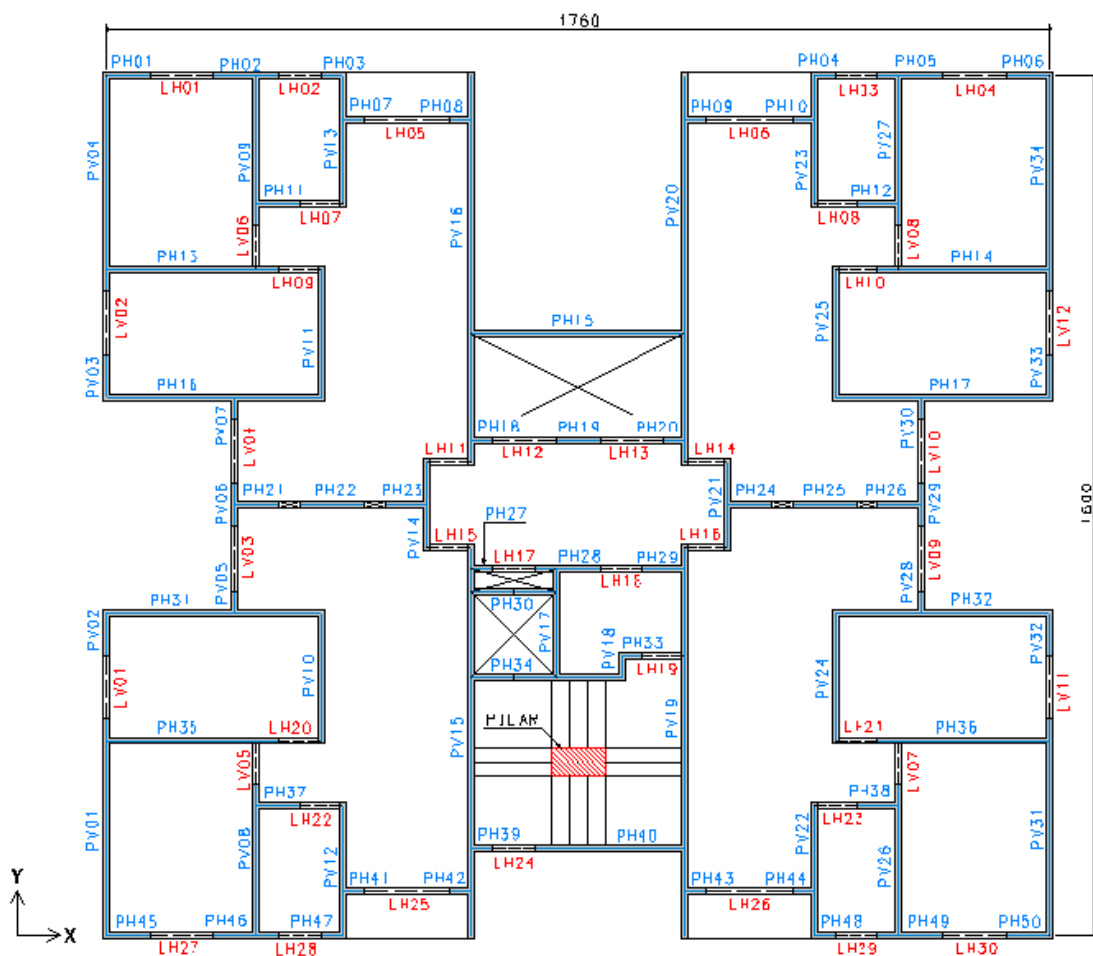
Planta baixa quadrada (Fonte: Braguim, 2013).
